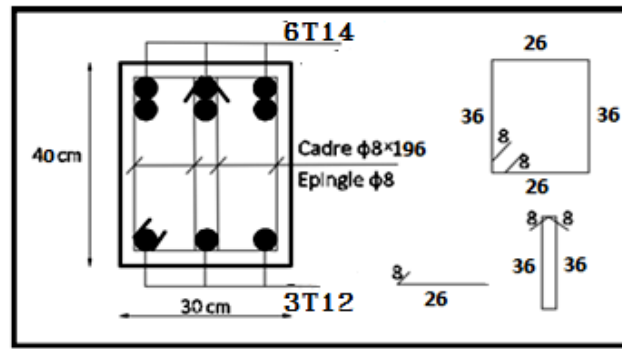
Dessin de ferrailage de la poutre brisée en appui
